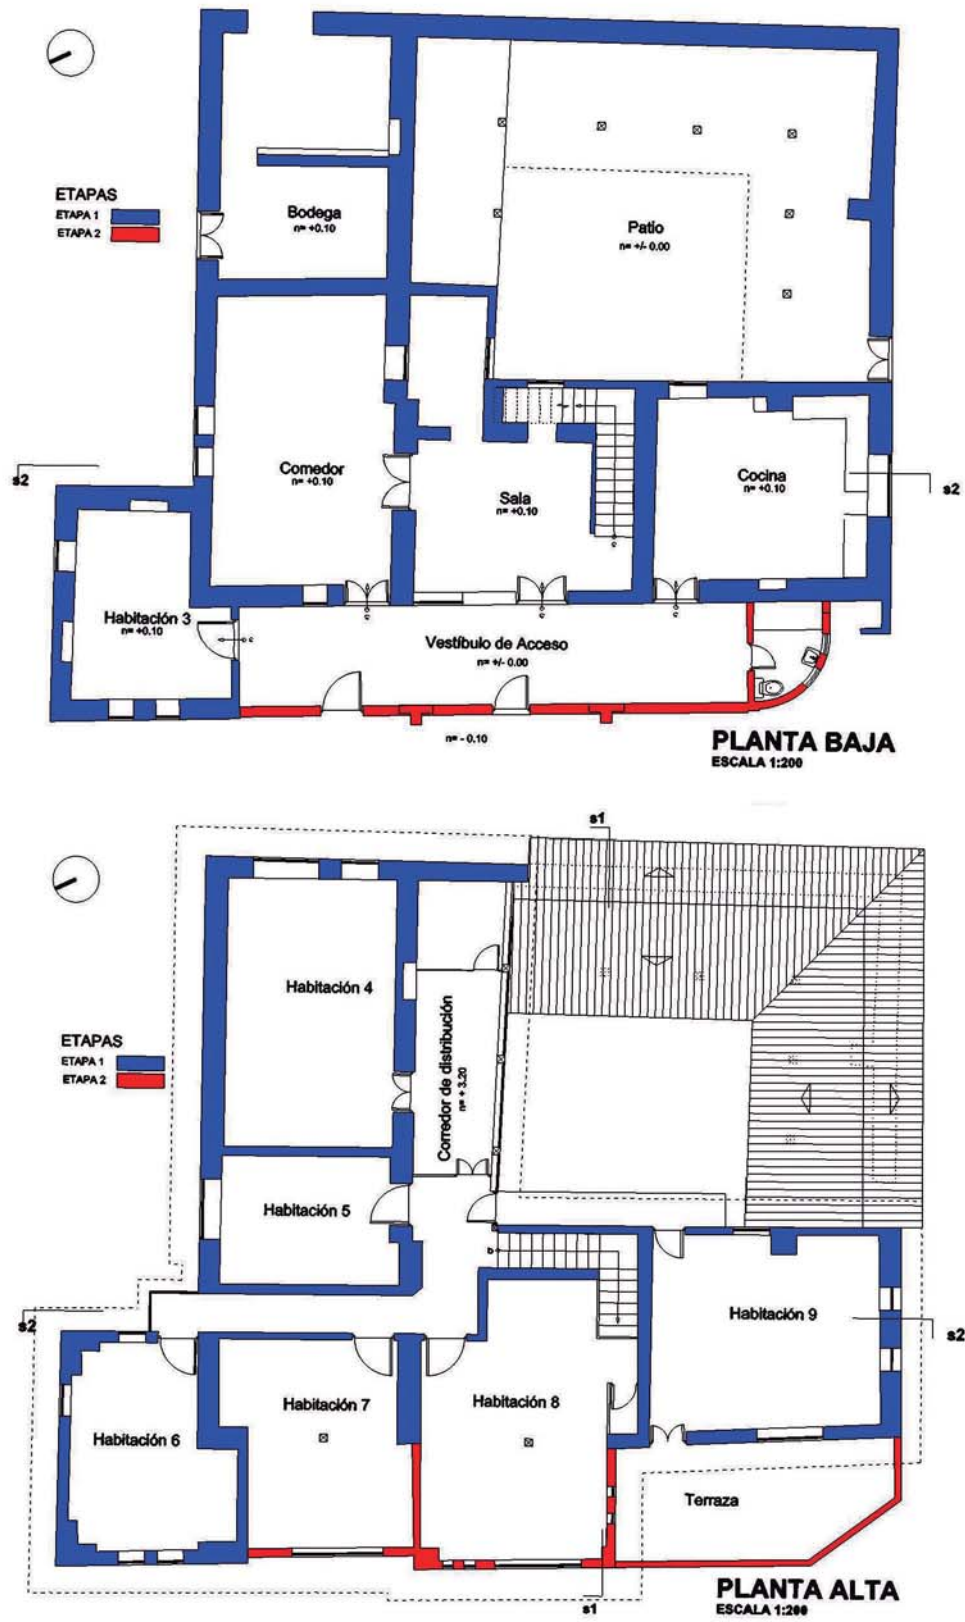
Planta baja y planta alta previo a proceso de restauración, año 2008.
